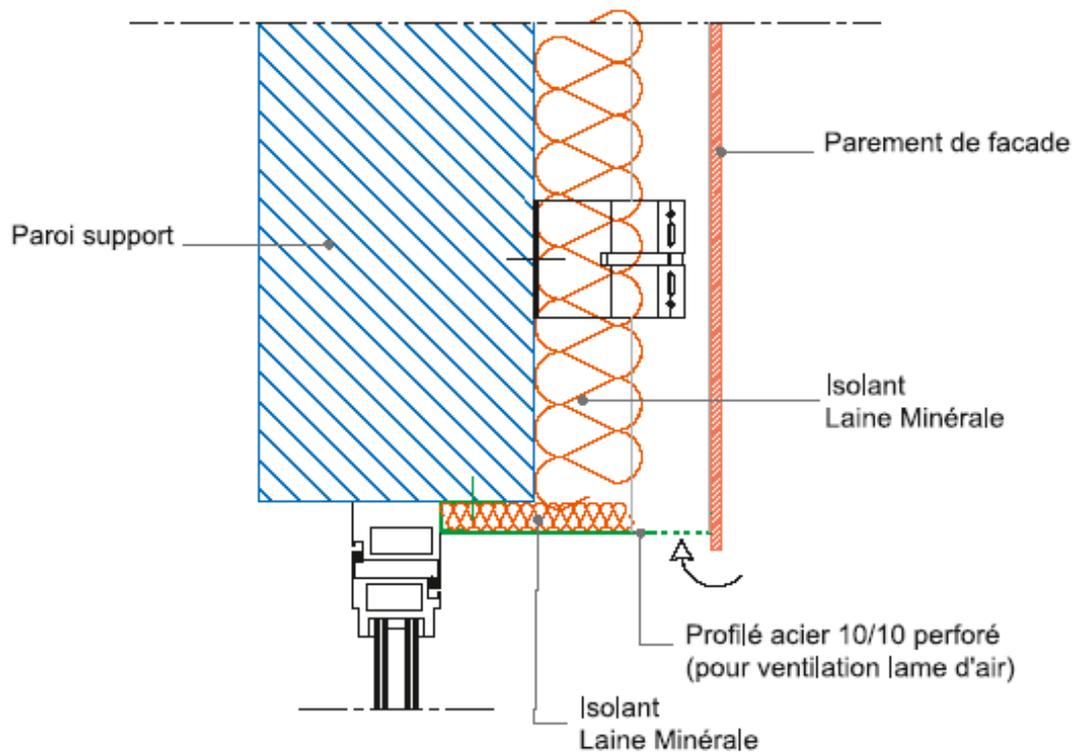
Coupe verticale encadrement de la baie niveau linteau
